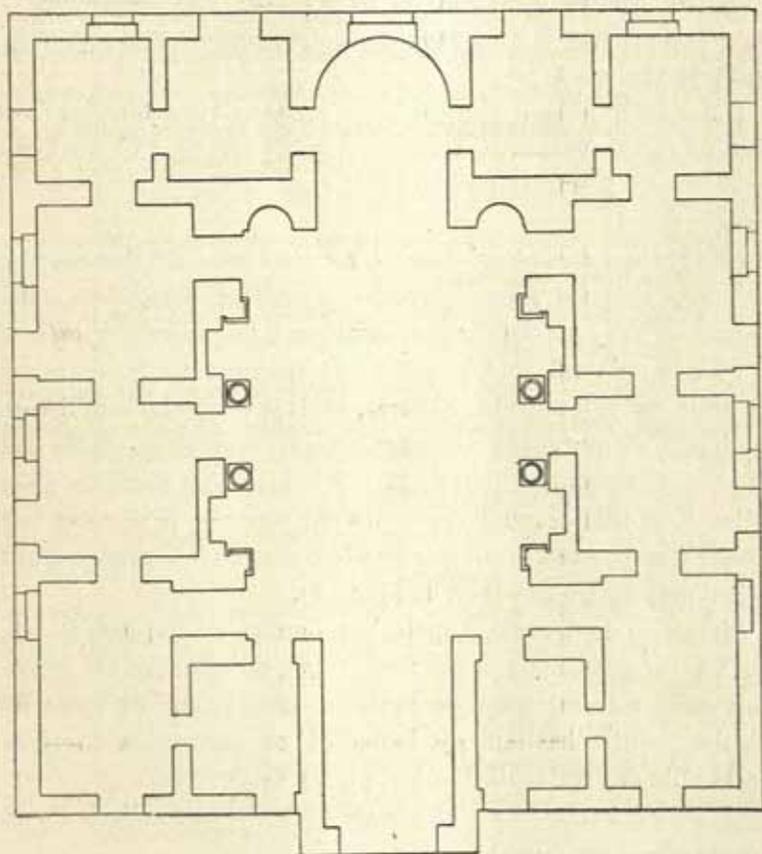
Plan d'un temple sur la Via Appia (n° 47).
